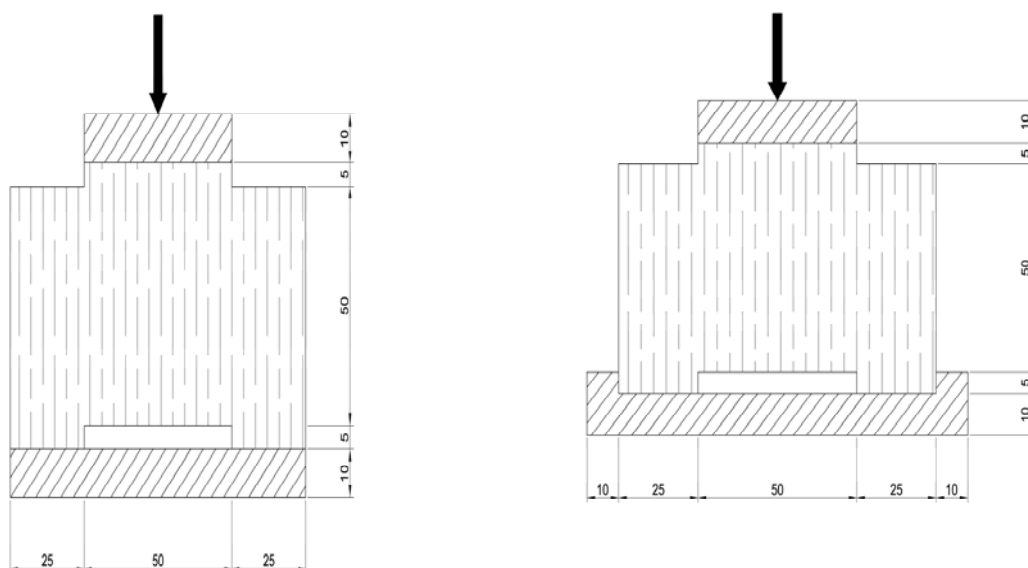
Detalhe do ensaio para cisalhamento em dois planos
